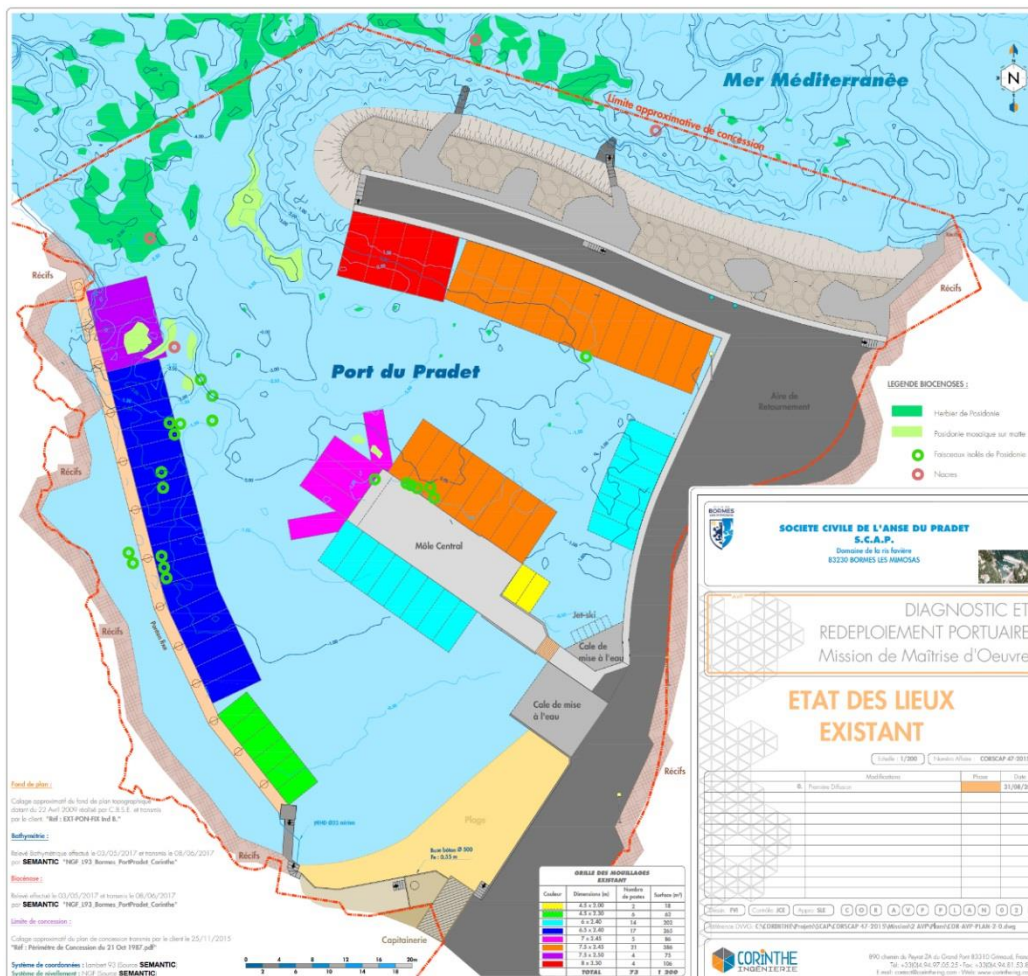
Plan du port de plaisance de l'Anse du Pradet dans sa configuration actuelle
